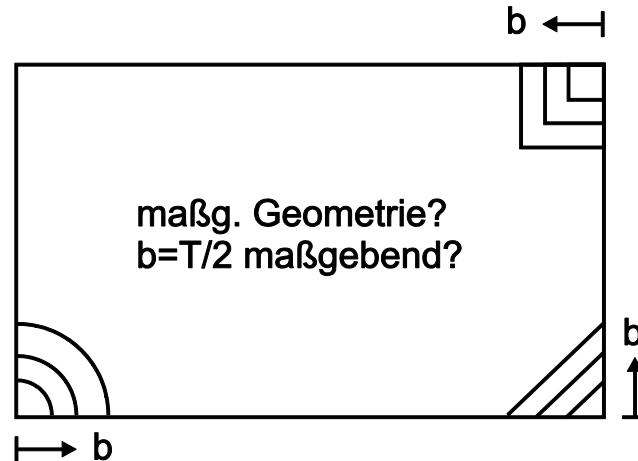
Maßgebender Bruchkörper im räumlichen Fall (Grundriss)
